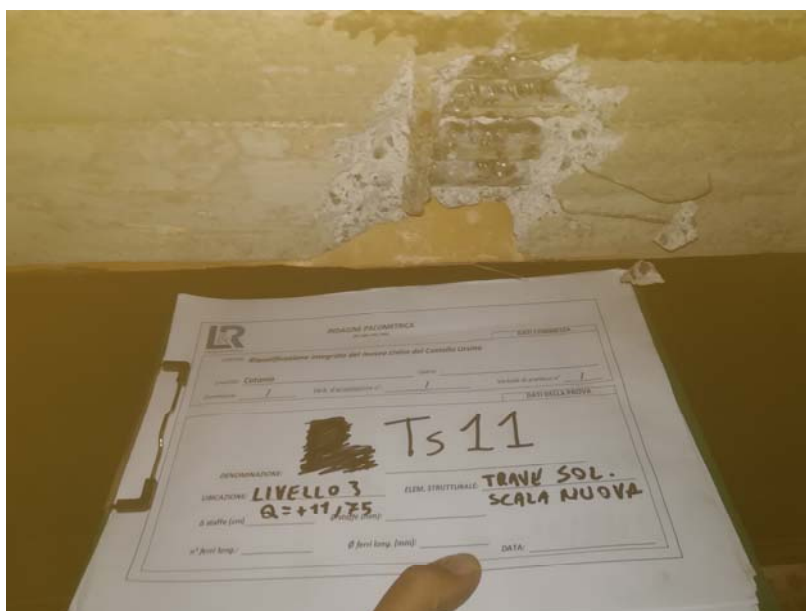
Traccia strutturale trave - 3° Livello quota +11.75 m
